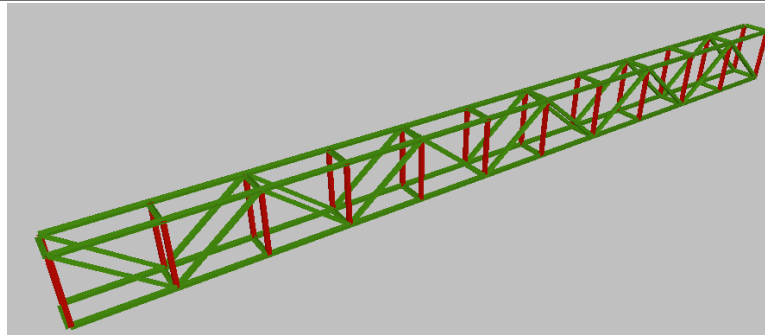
Vista 3D sección cercha para viaducto entre cámaras N30-N31 Y N38-N39
